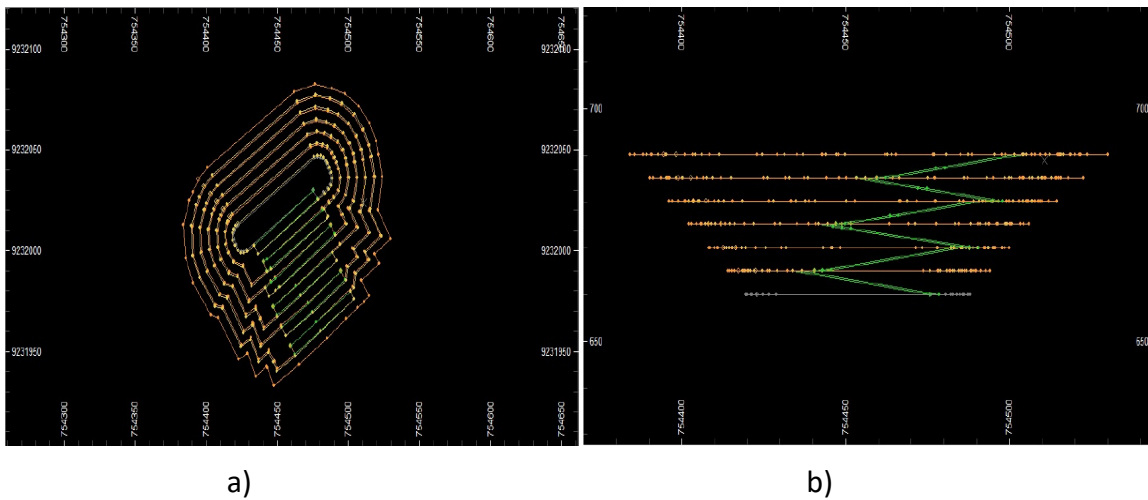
Projeto do segundo cenário de lavra proposto, cava em zig-zag - a) vista superior; b) perfil leste-oeste.
